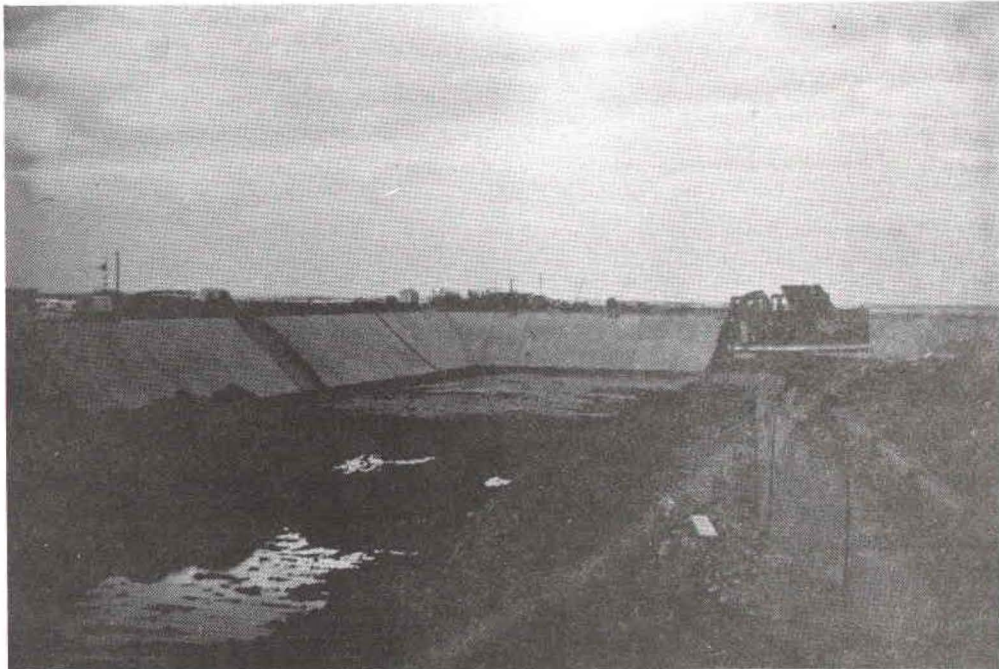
Construction du nouveau port de plaisance à Grandcamp.
